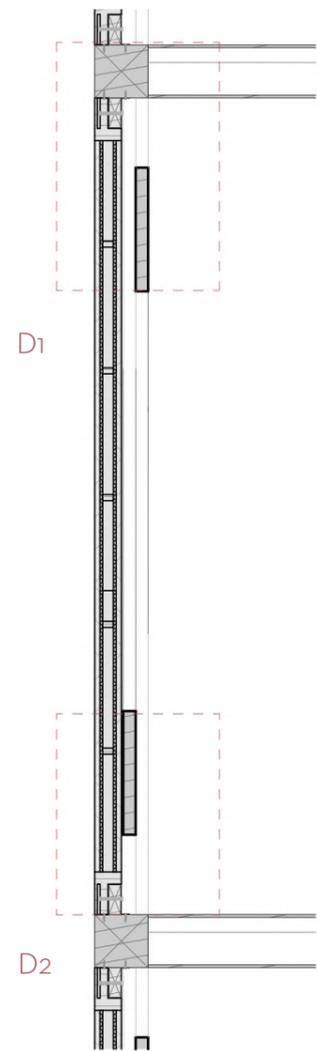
Sección constructiva panel. Fuente: Elaboración propia
